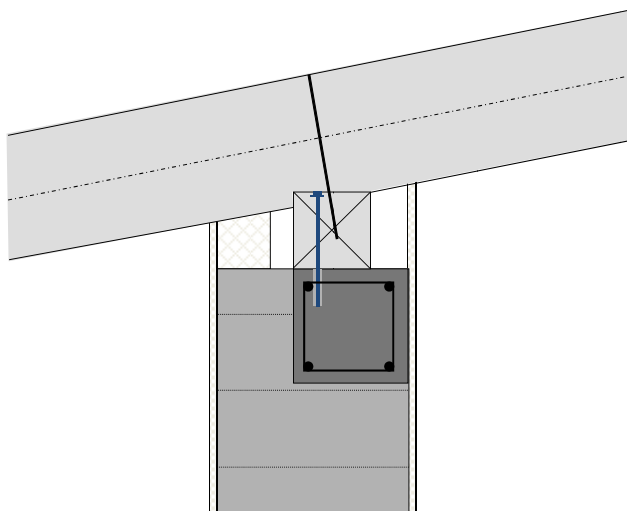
Cordolo sulla parete in muratura, su cui è fissato un dormiente in legno per semplificare il montaggio e il fissaggio della copertura
